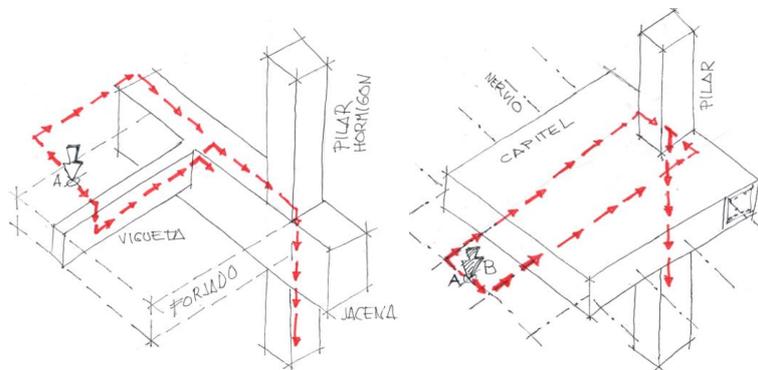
Transmisión de cargas a un pilar en forjado unidireccional y en un reticular.
